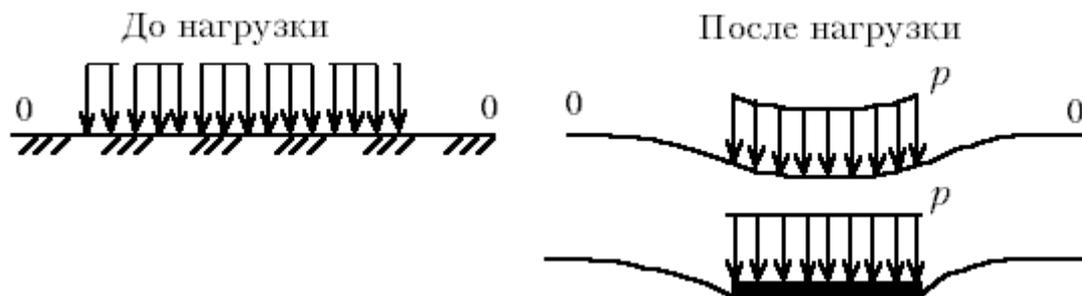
Перемещение точек поверхности грунта при приложении постоянной нагрузки
